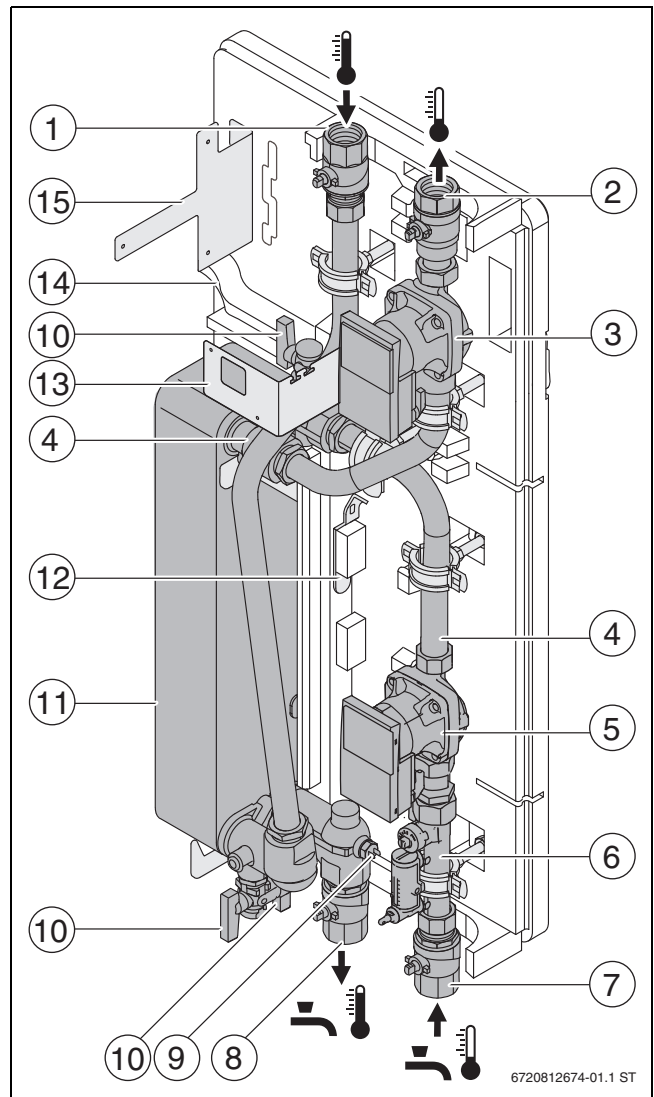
Station SLP1/3 ohne vorderen Wärmeschutz
